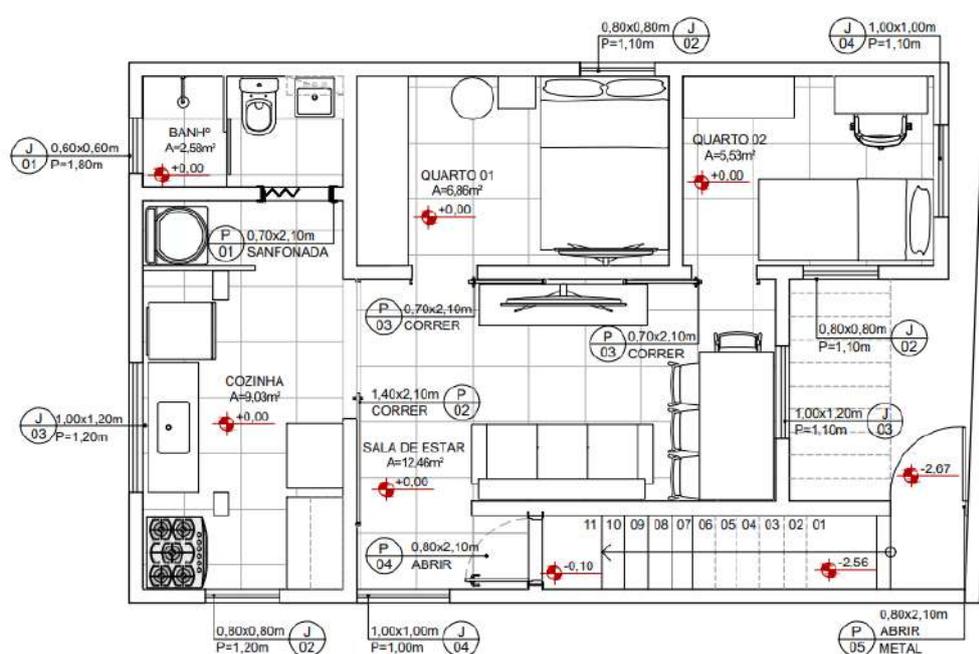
Planta da Casa 3 após intervenções de melhoria de habitabilidade
